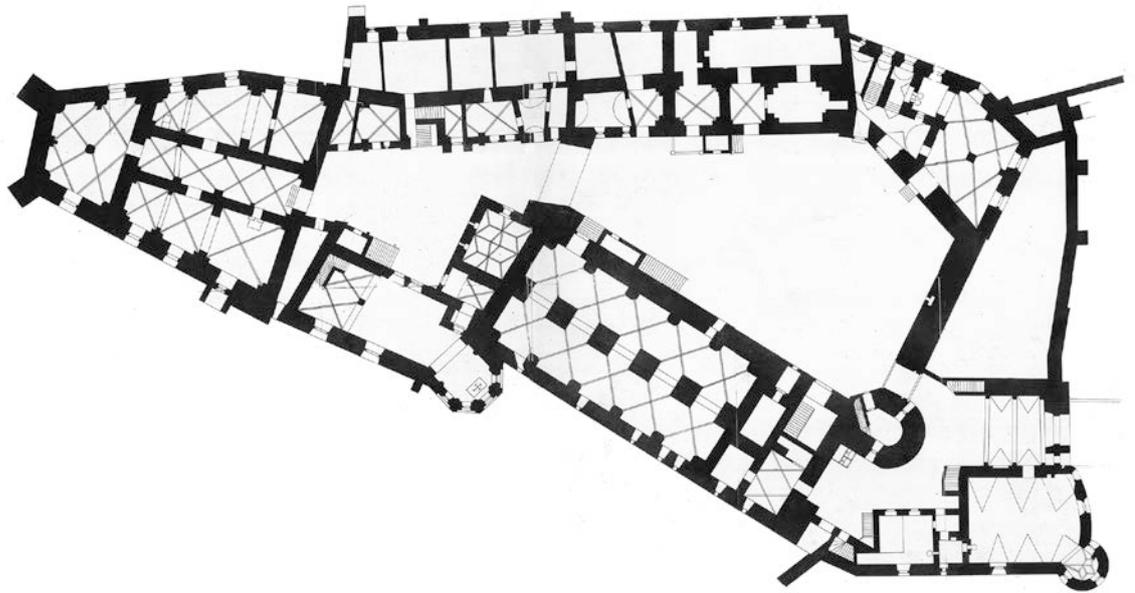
Grundriss Erdgeschoss Hauptburg Burghausen
